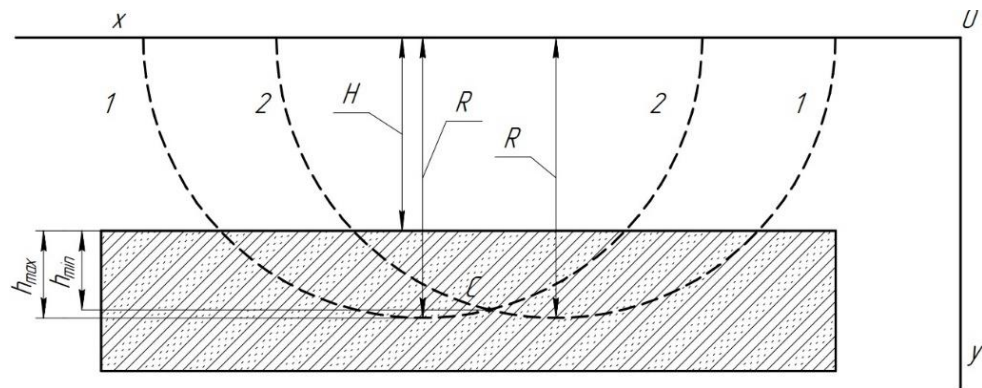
Схема визначення глибини обробки дисковою фрезою
